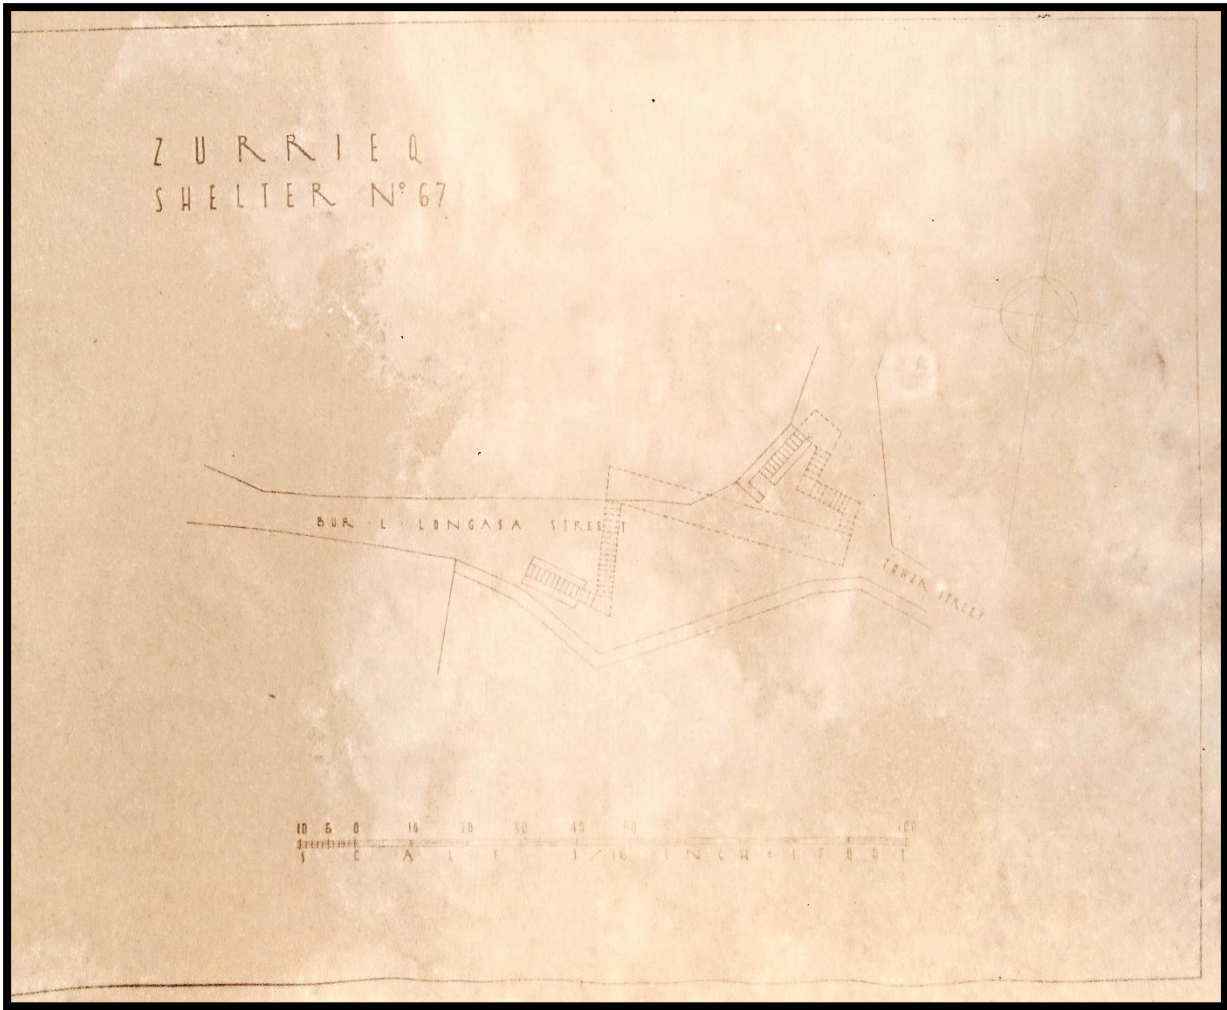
Planta do Abrigo nº67 "Bur IL Longasa Street* – Tower Street"
